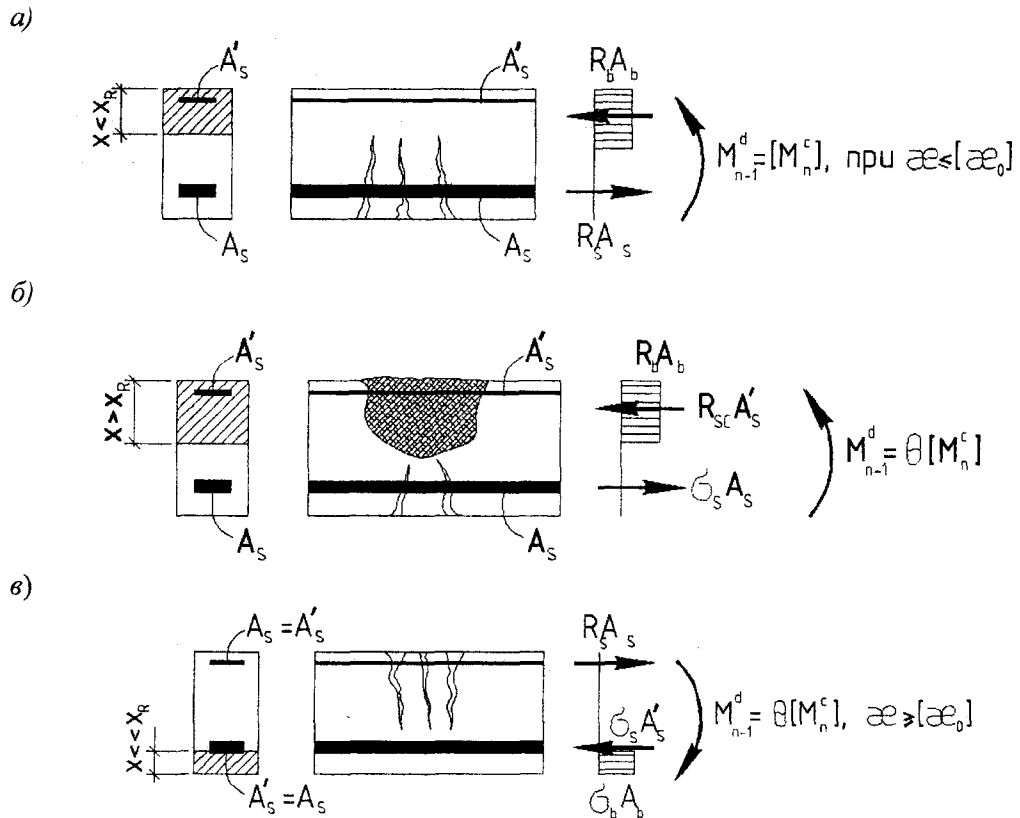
Случаи разрушения железобетонных элементов в запредельных состояниях: а - пластическое «мягкое»; б - внезапное хрупкое по бетону сжатой зоны; в - внезапное хрупкое по недоармированному сечению
